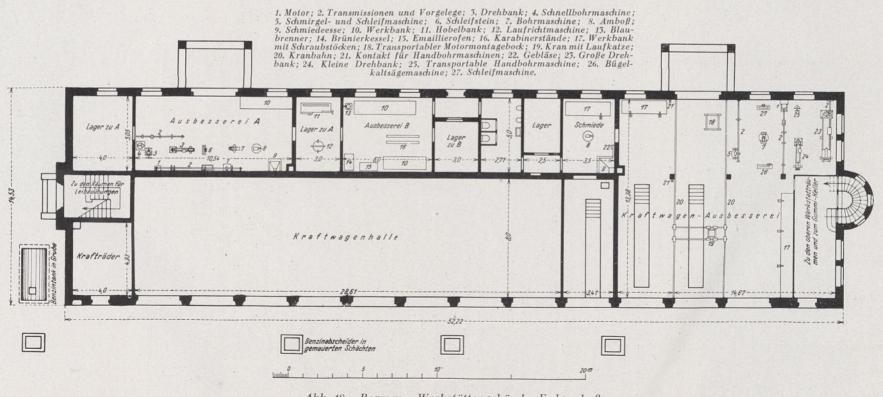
Barmen. Werkstättengebäude, Erdgeschoß.
